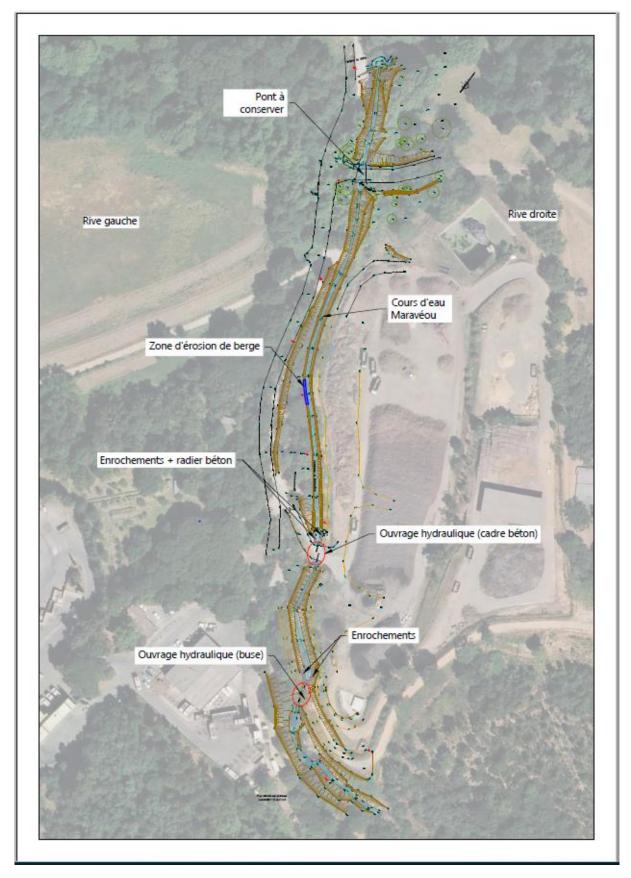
Plan topographique état initial (échelle: 1/1500eme)
